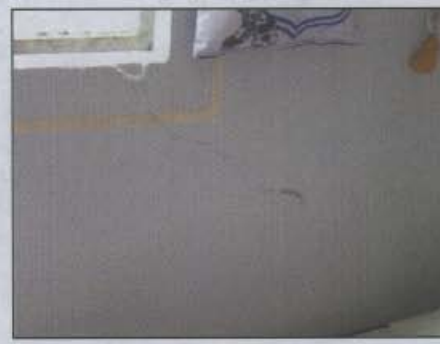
Grieta horizontal en el muro fachada del segundo piso de la casa de la Calle 33 Bis Sur # 93 - 01
